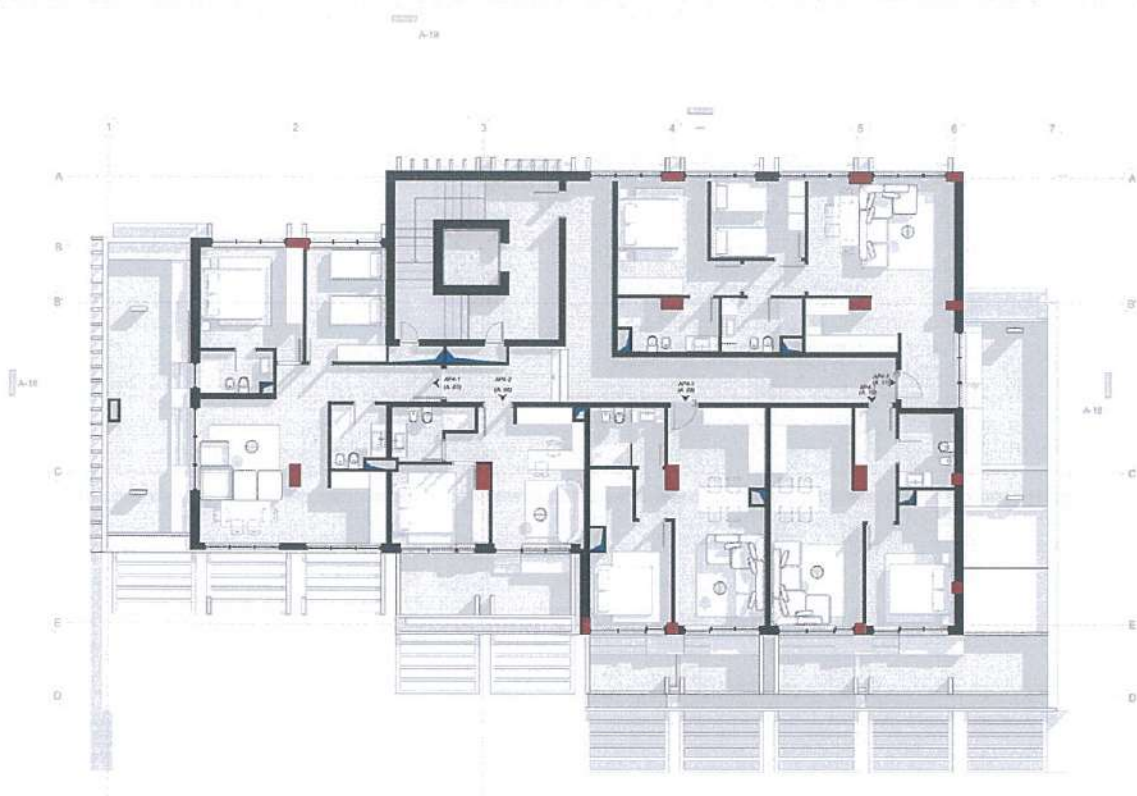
Planimetria e mobiluar e katit +4 South Hotel
